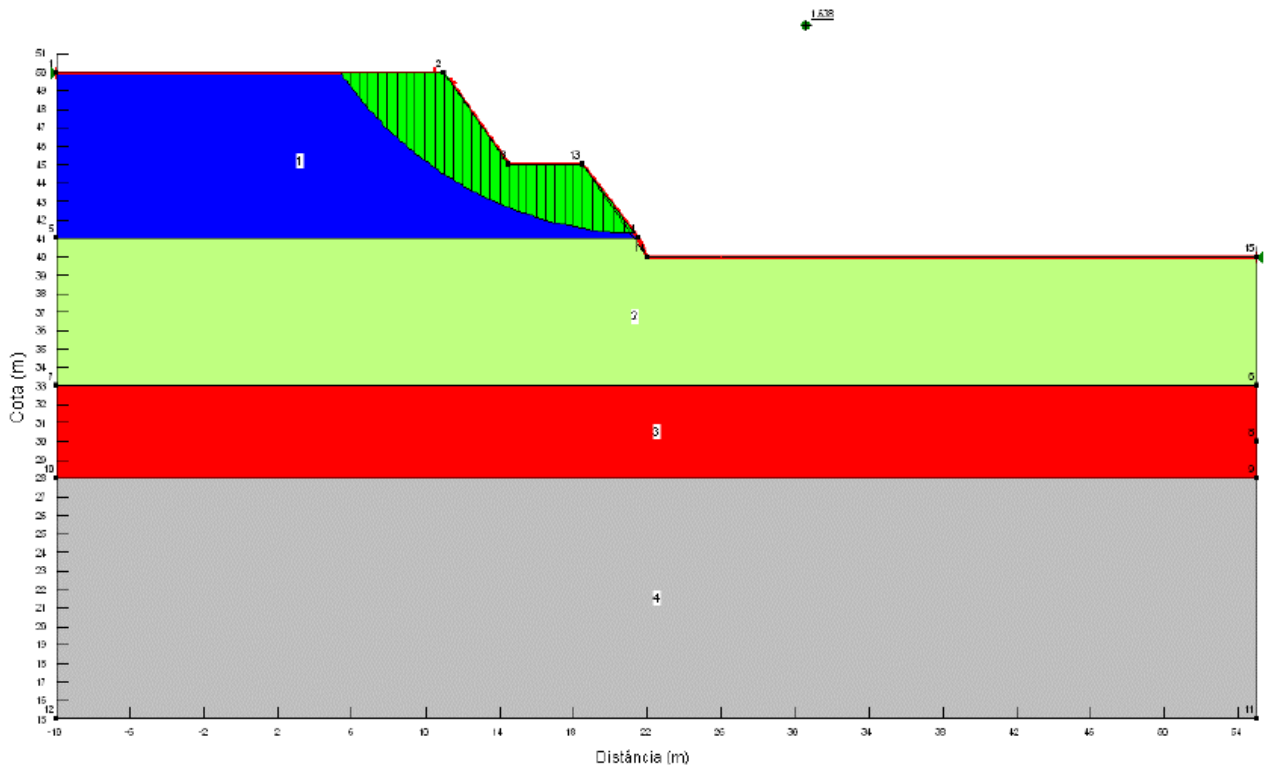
Detalhe da seção transversal de estudo, para o caso 4, com execução de retificação (retaludamento) da geometria natural do talude, após o voçorocamento.
